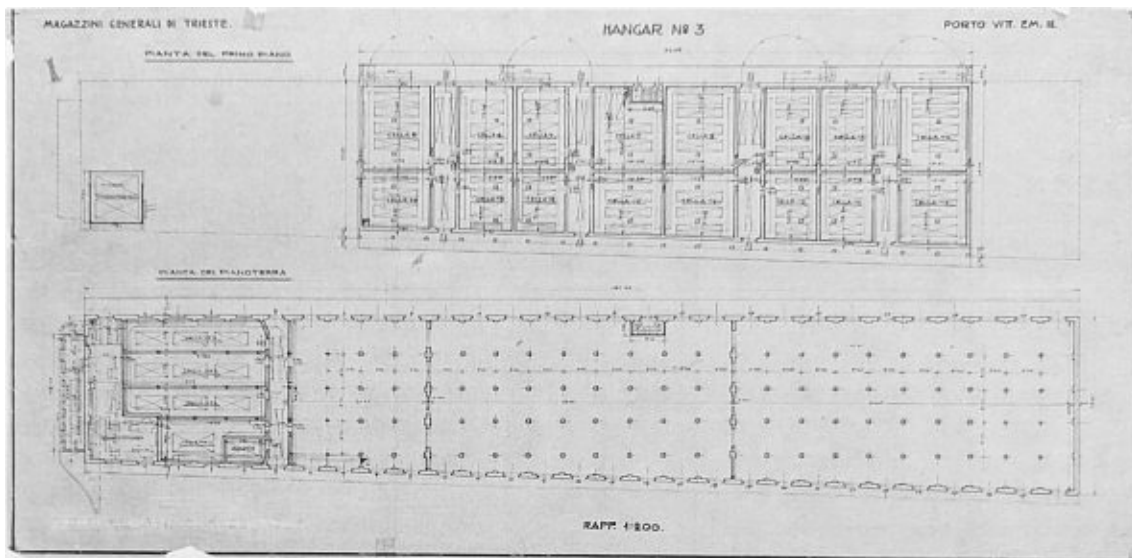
Lagerhaus 3, Grundriss
